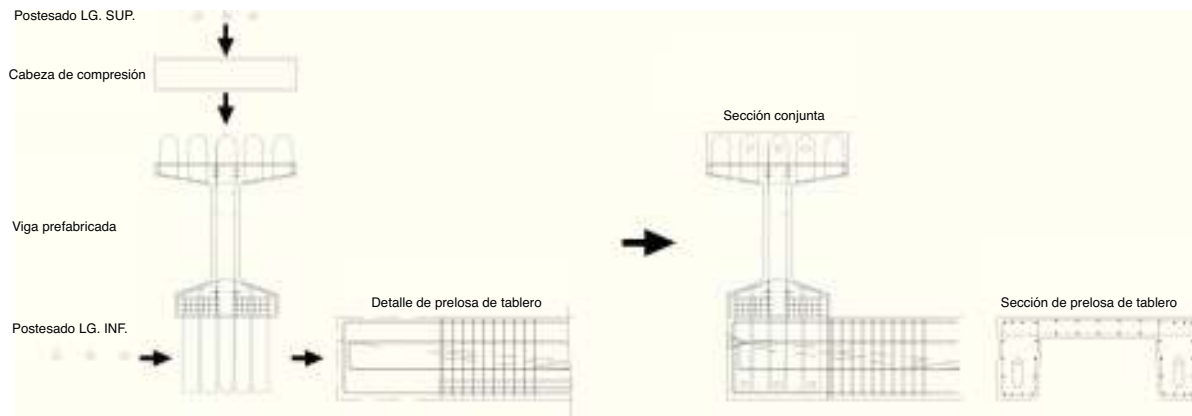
Variante solución 1 con viga longitudinal prefabricada. Sección constructiva.
